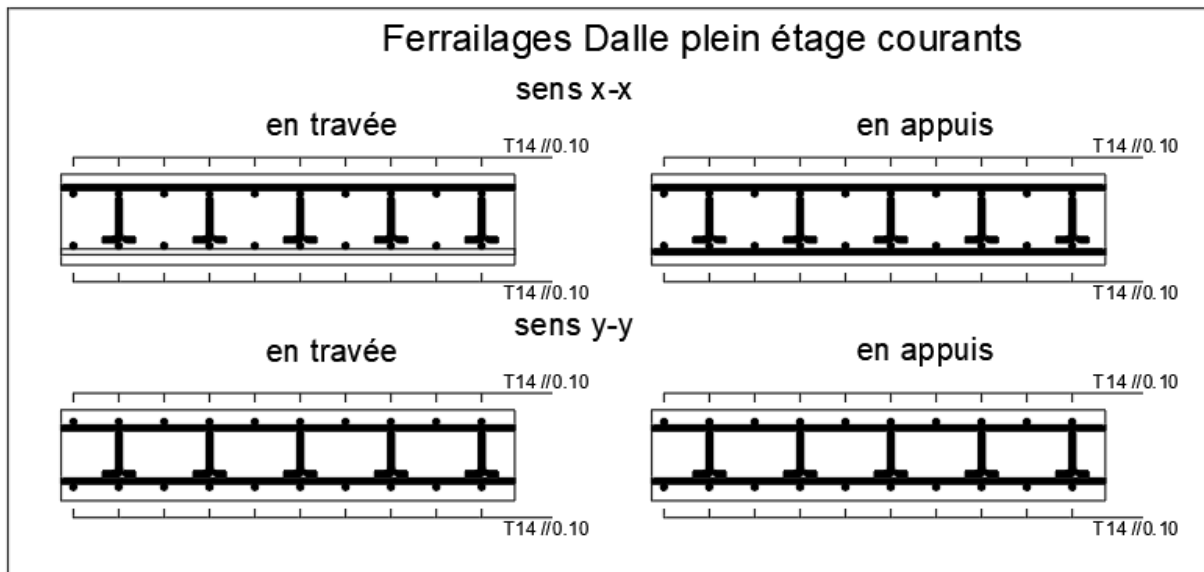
Schéma de Ferrailages Dalle plein étages courants.
